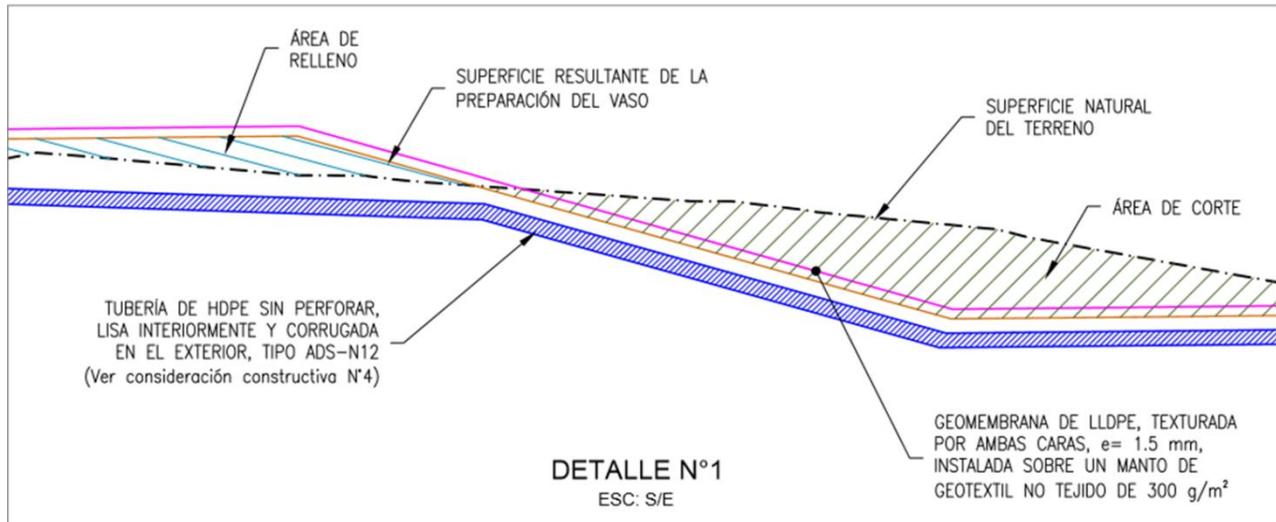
17. Cubierta impermeable y sistema de drenaje interno
